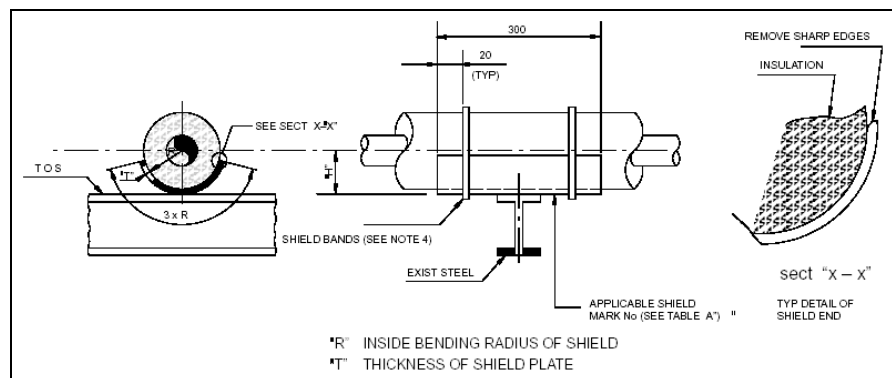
Cubiertas de protección aislante para tuberías 1½" o menores.
